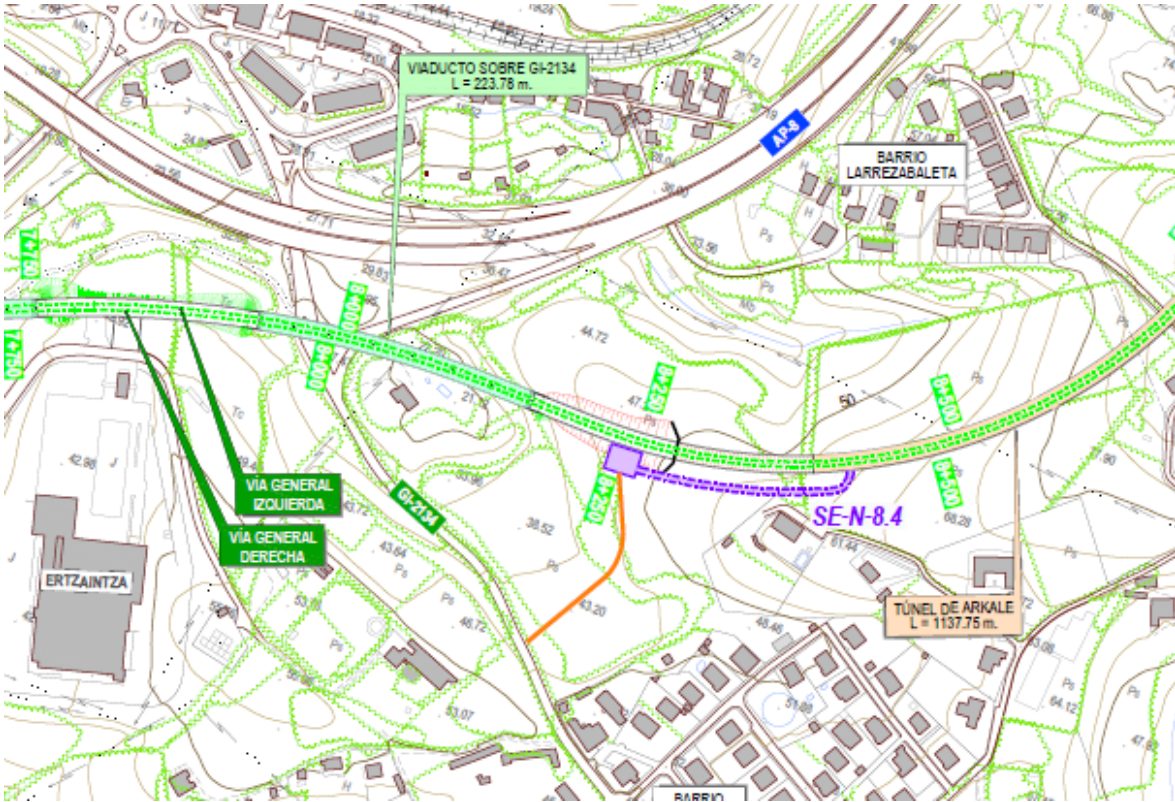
Localización de la galería de emergencia SE-N-8.4 de los túneles de Arkale y del Ramal al Puerto (Alternativa Norte).
